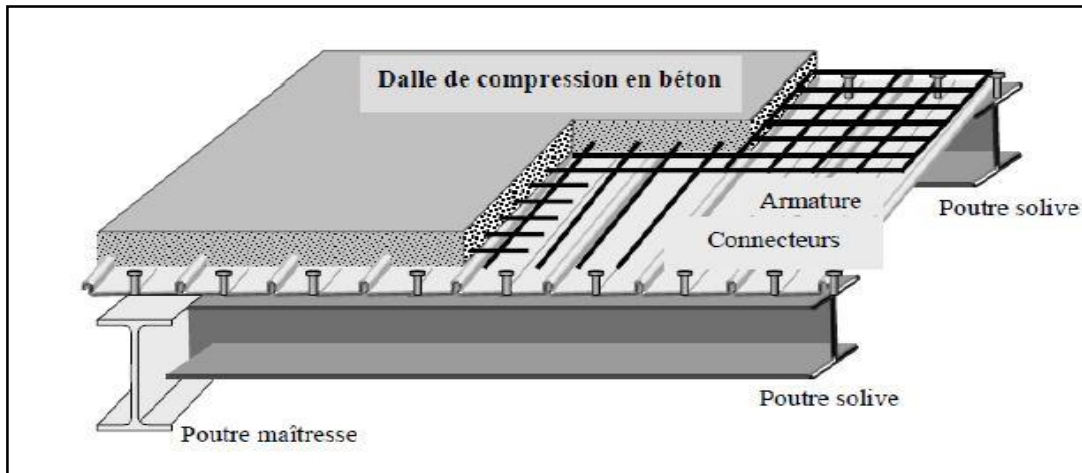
Plancher mixte avec des connecteurs acier-béton
